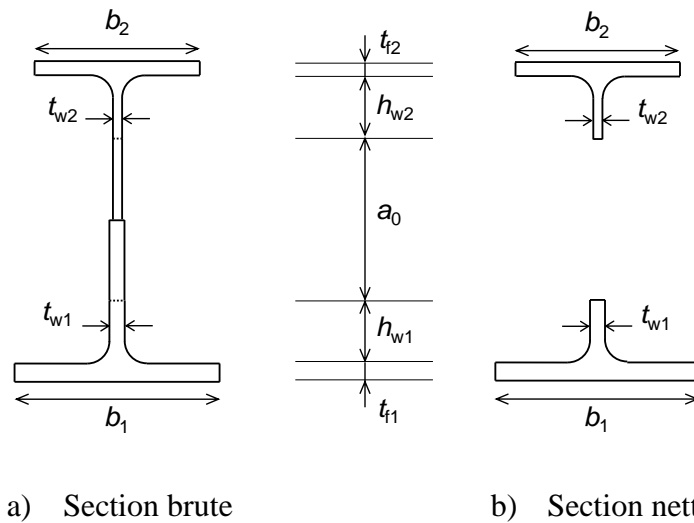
Dimensions de la section d'une poutre cellulaire
